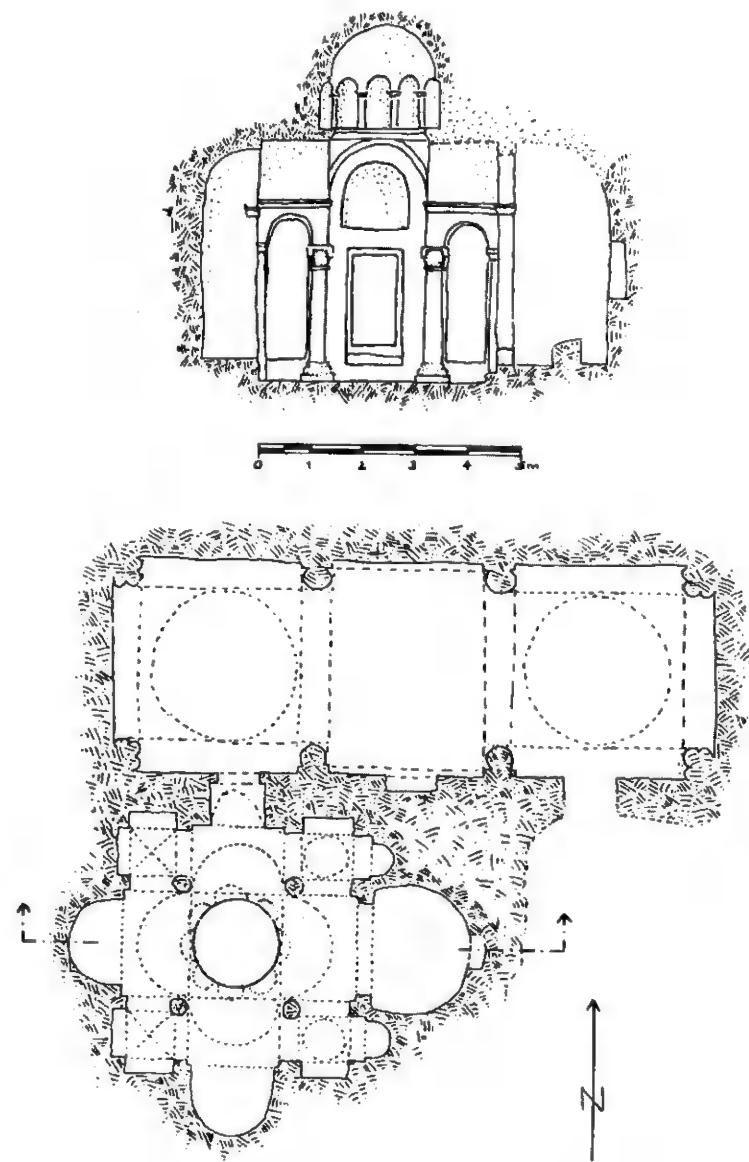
Längsschnitt und Grundriß der Yokuş Başı Kilisesi
